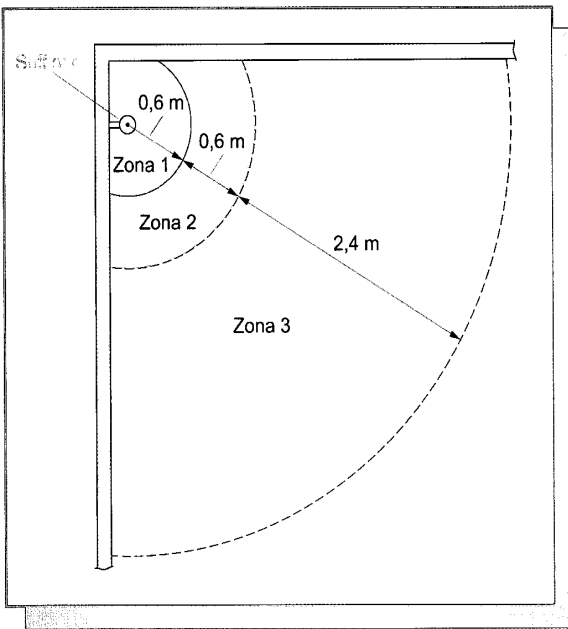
Zone di rispetto in un locale doccia senza piatto doccia secondo la vecchia norma CEI 64-8 (pianta).
